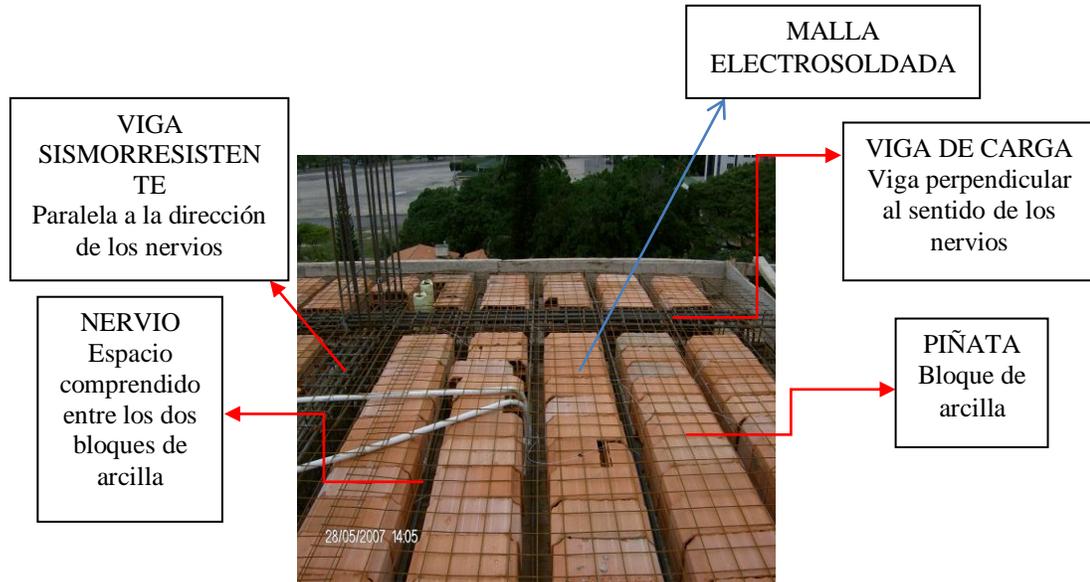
Planta de Envigado de entrepiso armada lista para vaciar. Losa nervada en una dirección (Edificio de apartamentos). Nota. Bonucci (2012).
